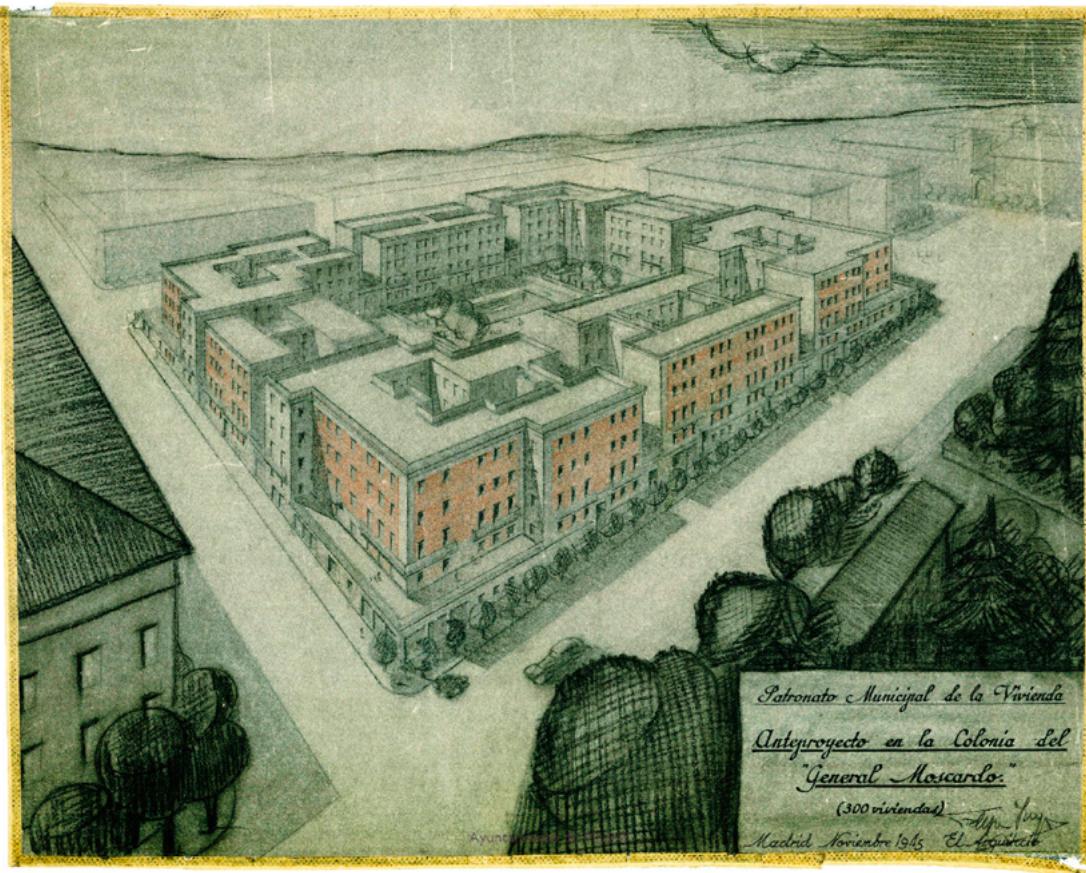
Anteproyecto de 253 viviendas en la Colonia Moscardó. Plano GM- 2, 1945. Según punto de vista, es calle La Cuesta
